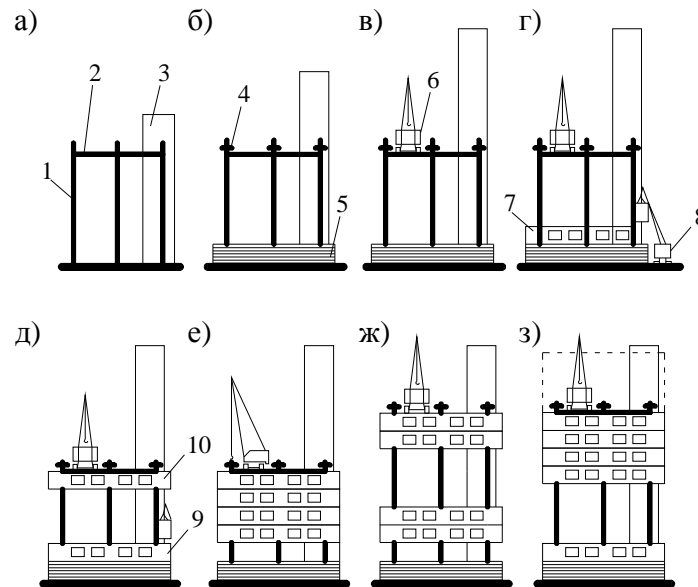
Схема монтажу будинку методом підйому поверхів:
